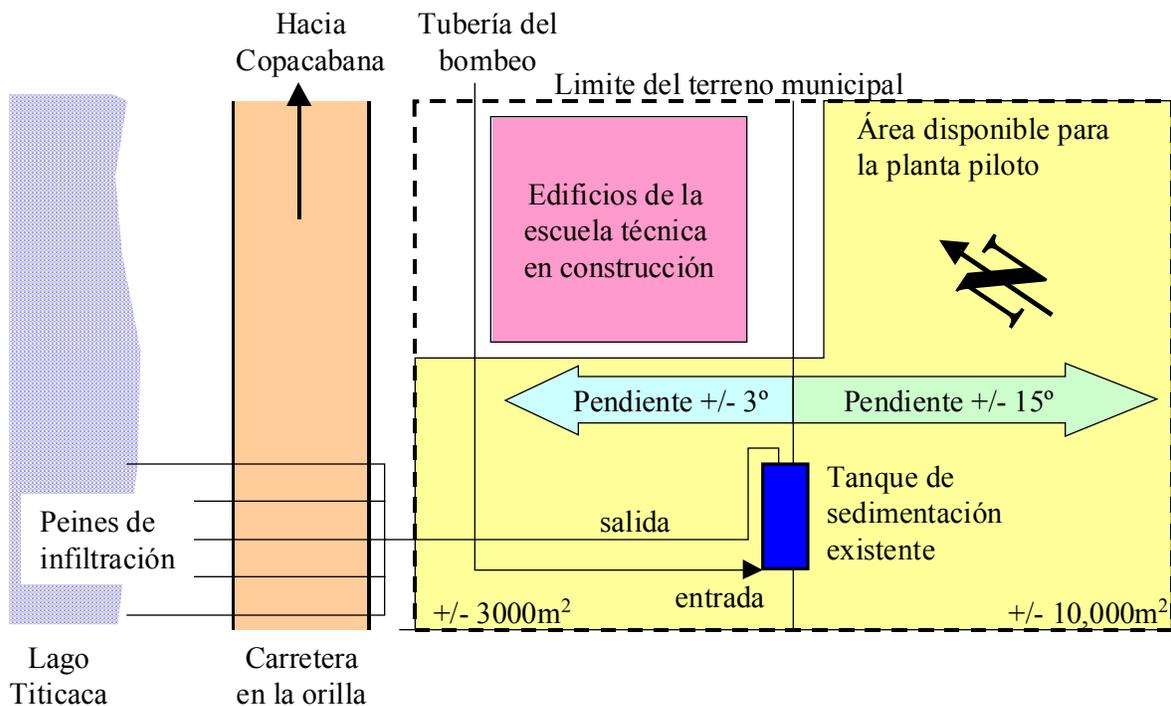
Esquema del área disponible para la planta piloto integrado al subsistema No. 1
